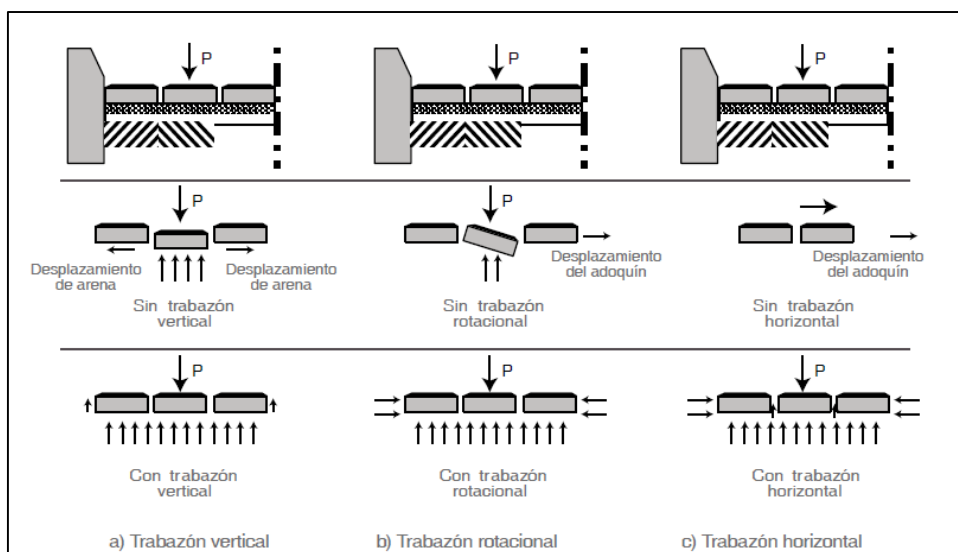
Trabazón vertical, horizontal y rotacional de un pavimento articulado.
